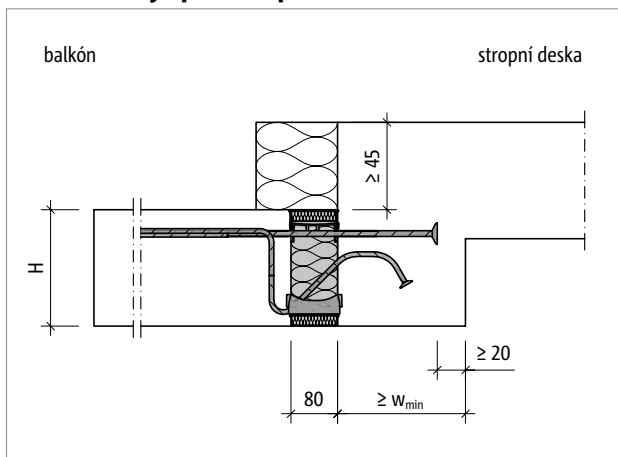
Schöck Isokorb® T typ KL-U/KL-O: Balkón na zalomené fasádě
